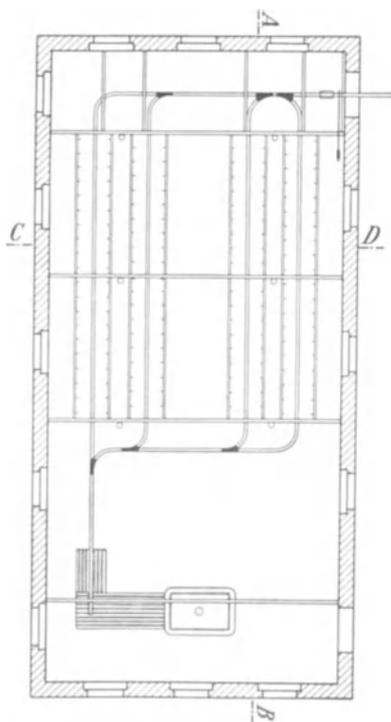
Grundriß einer Schweinehalle nach dem festen Pendelhakensystem.
